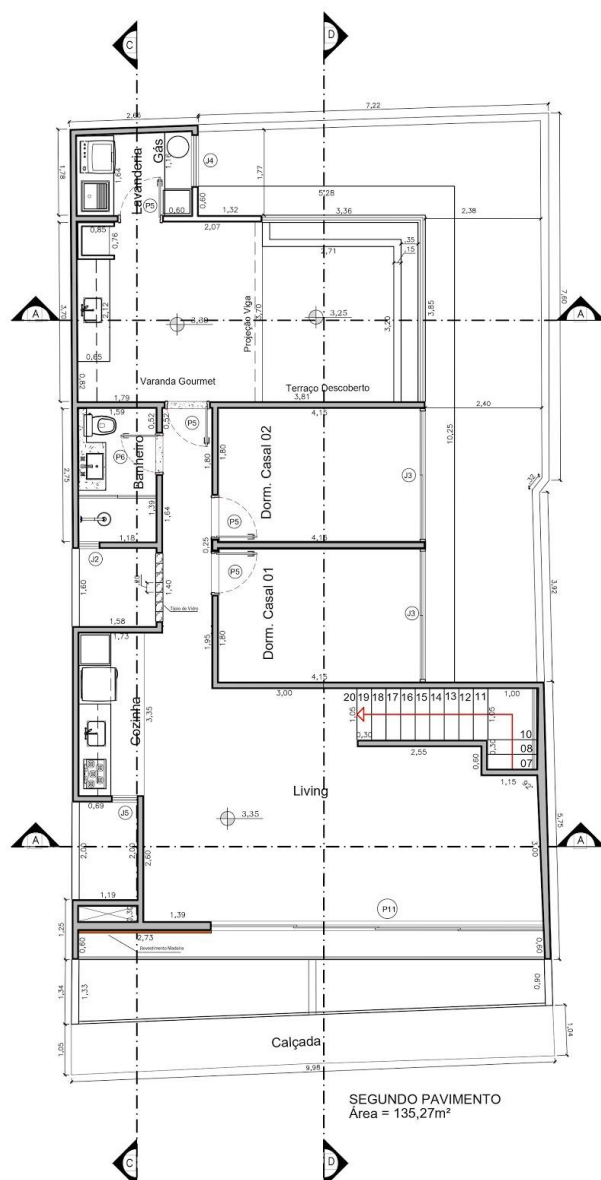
Planta executiva do Segundo Pavimento desenvolvido no AutoCAD.
